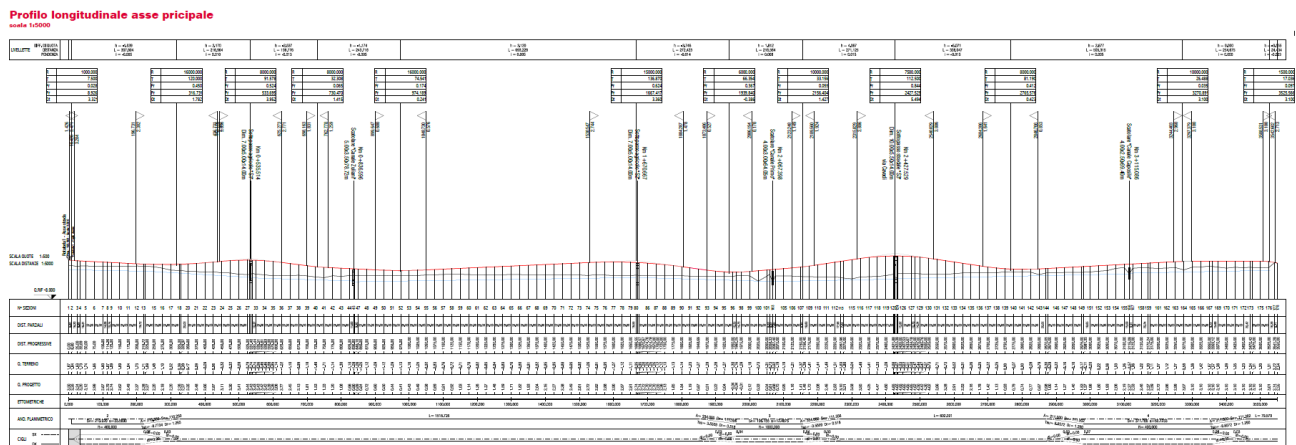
PROFILO DELL'INFRASTRUTTURA DI PROGETTO
